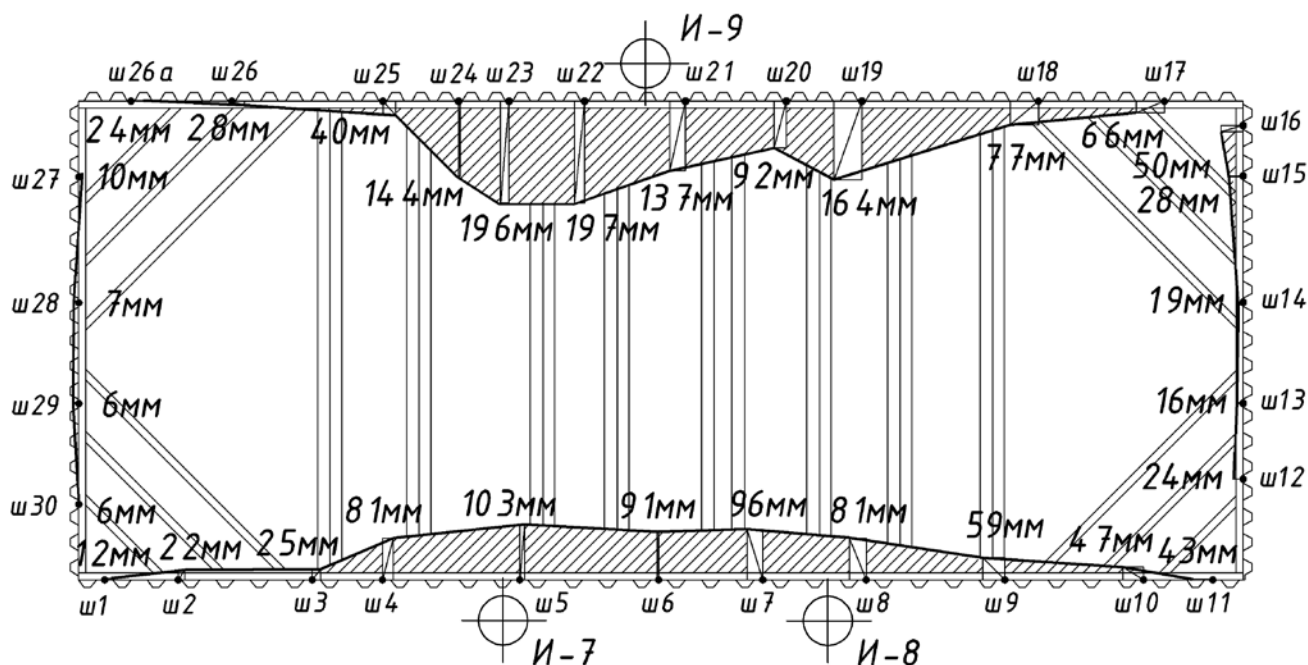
Сводная схема расположения геотехнического оборудования на котловане и эпюры перемещения верха шпунта на момент полного вскрытия котлована
